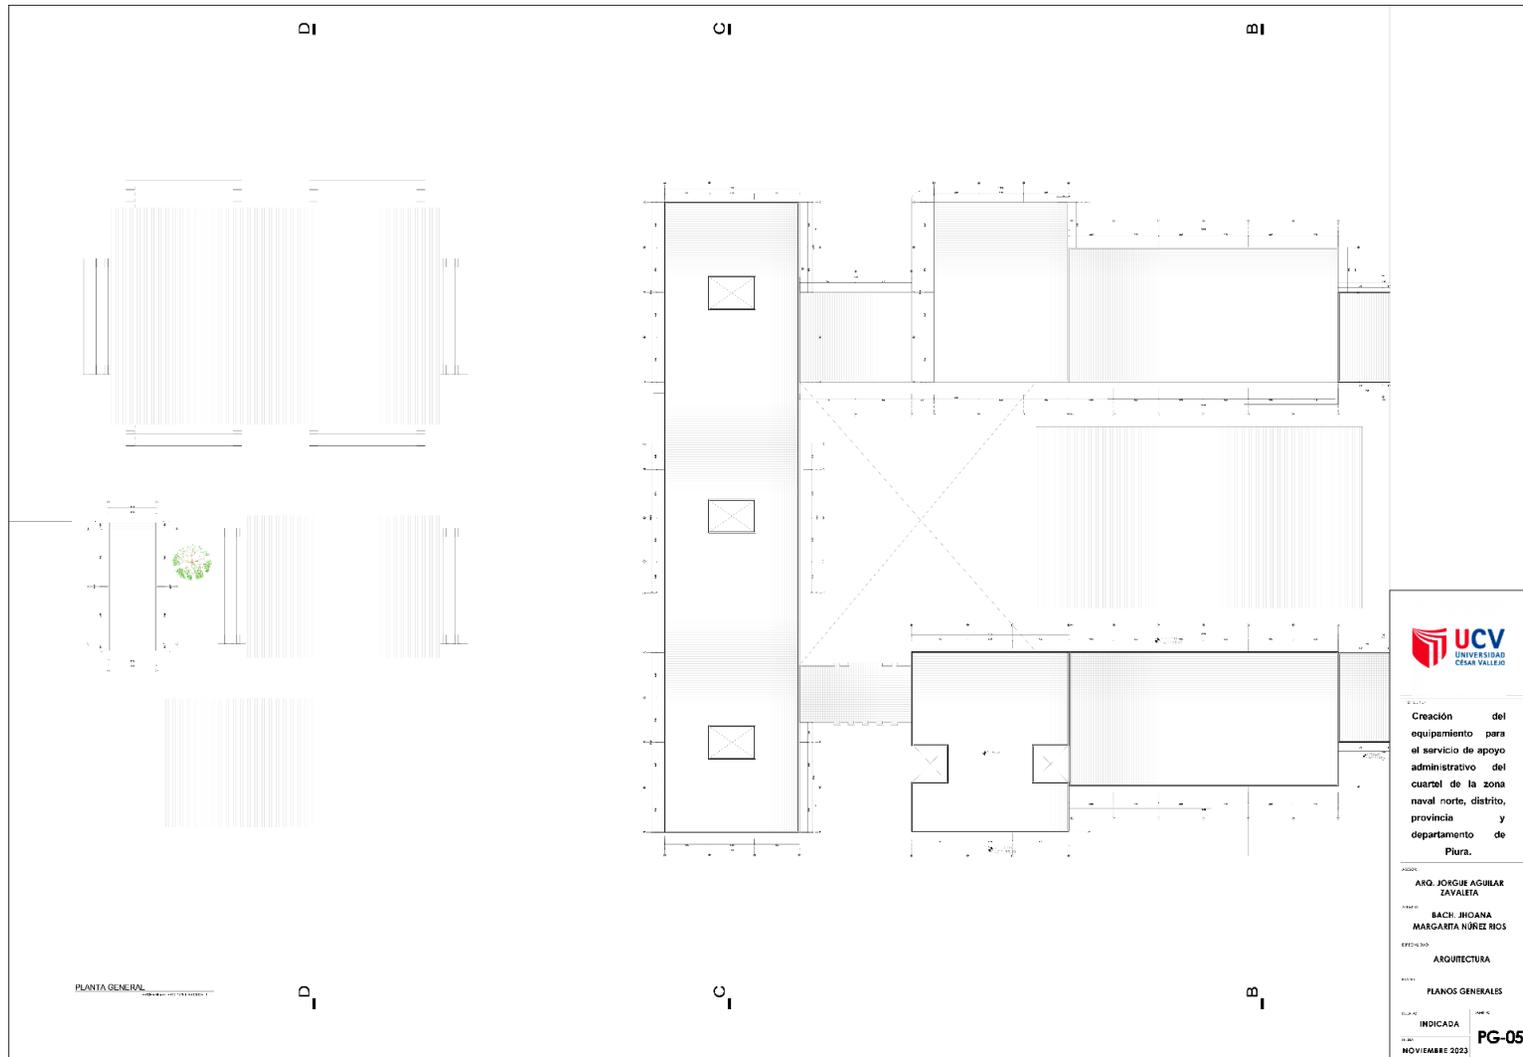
Planos Generales - Plano genera del tercer nivel – SECTOR 1
